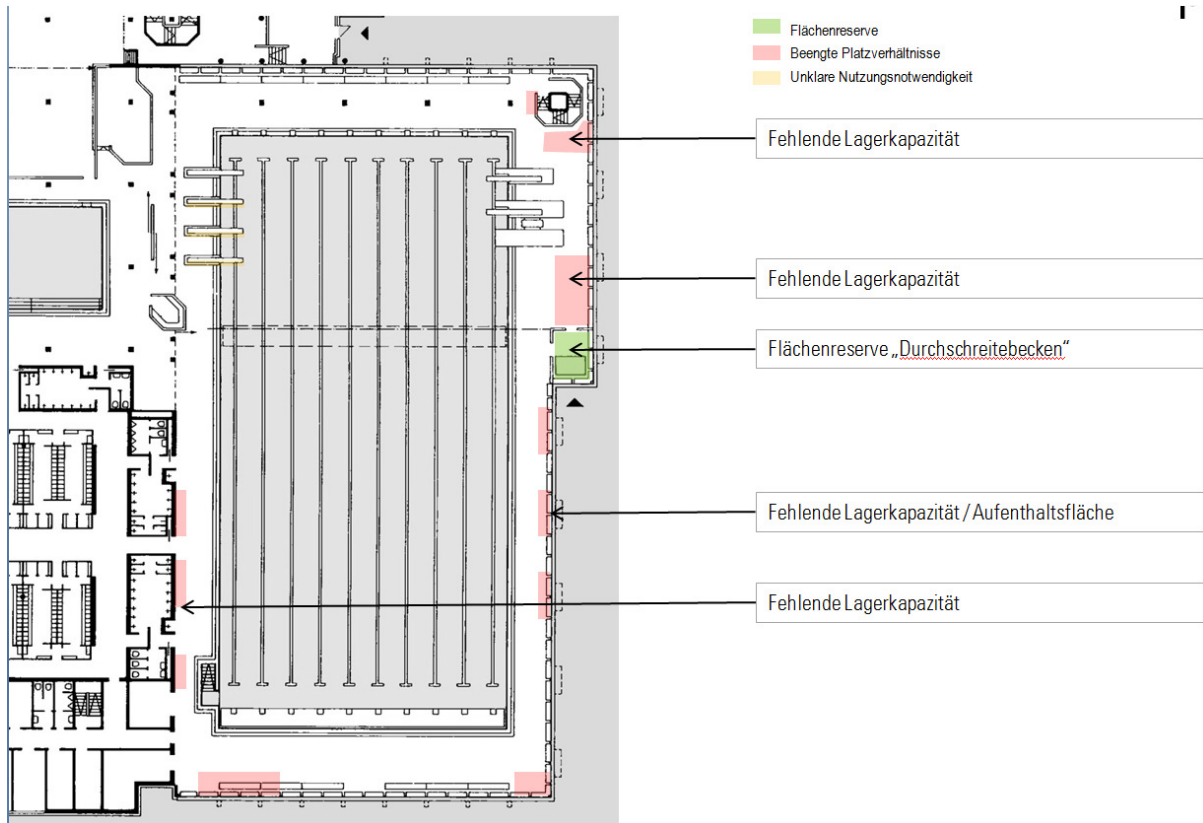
Grundrißbetrachtung: „Funktionen“ Teil 3 (Schwimmhalle)
